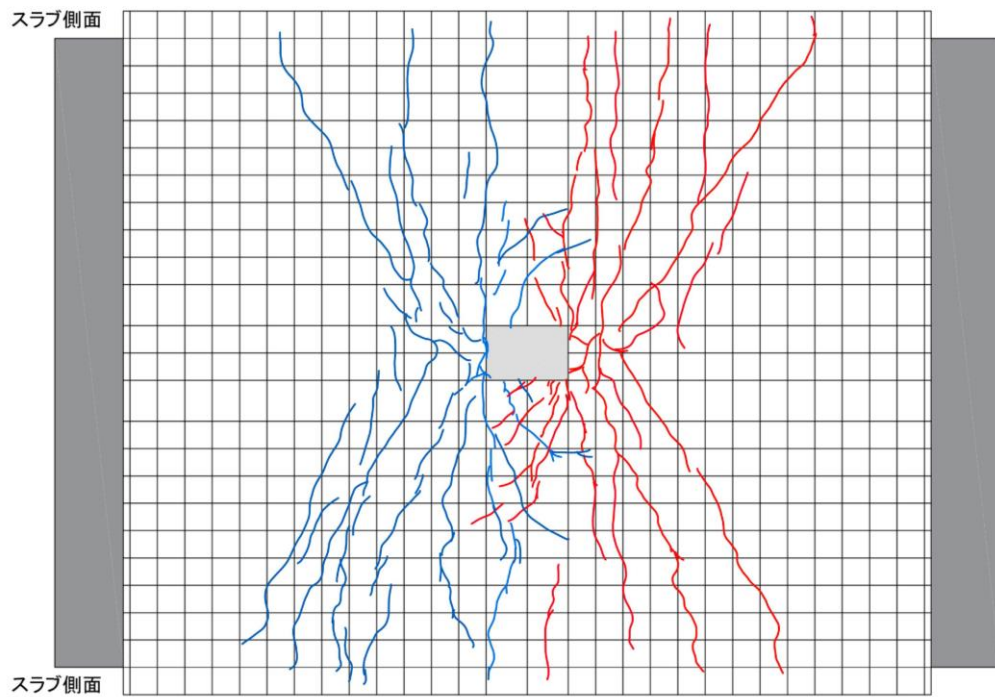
スラブ上面ひび割れ図(1/50rad)
